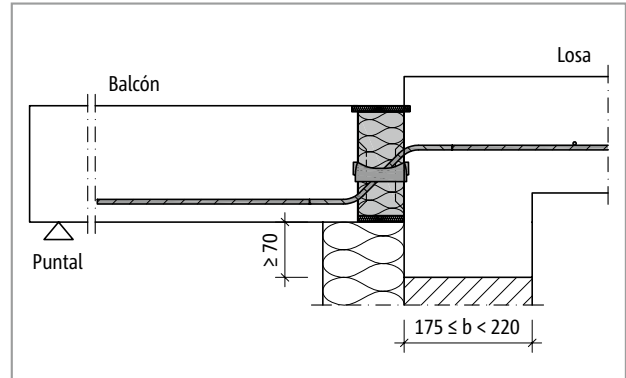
Schöck Isokorb® T tipo Q: Situación de montaje con ligero desfase de altura (p. ej., T tipo Q-V6 hasta Q-V12)
